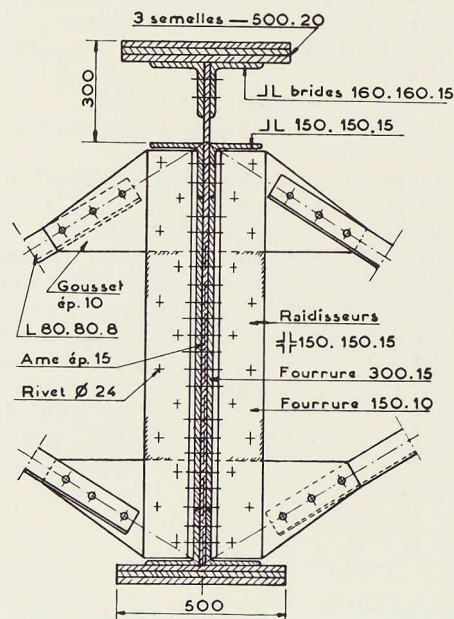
Coupe transversale d'une maîtresse-poutre.
